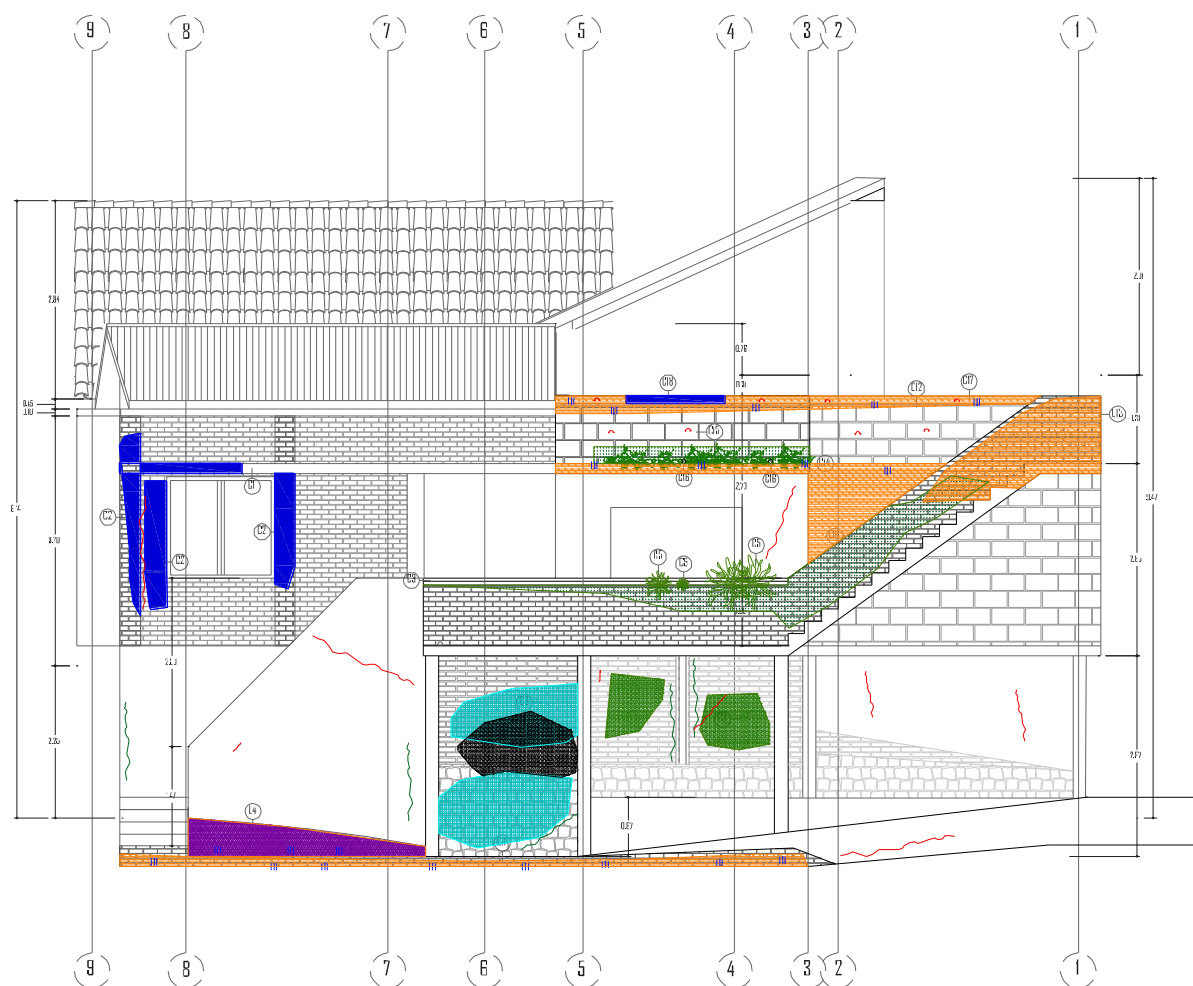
Diagnostico patológico de la estructura de cubierta.
